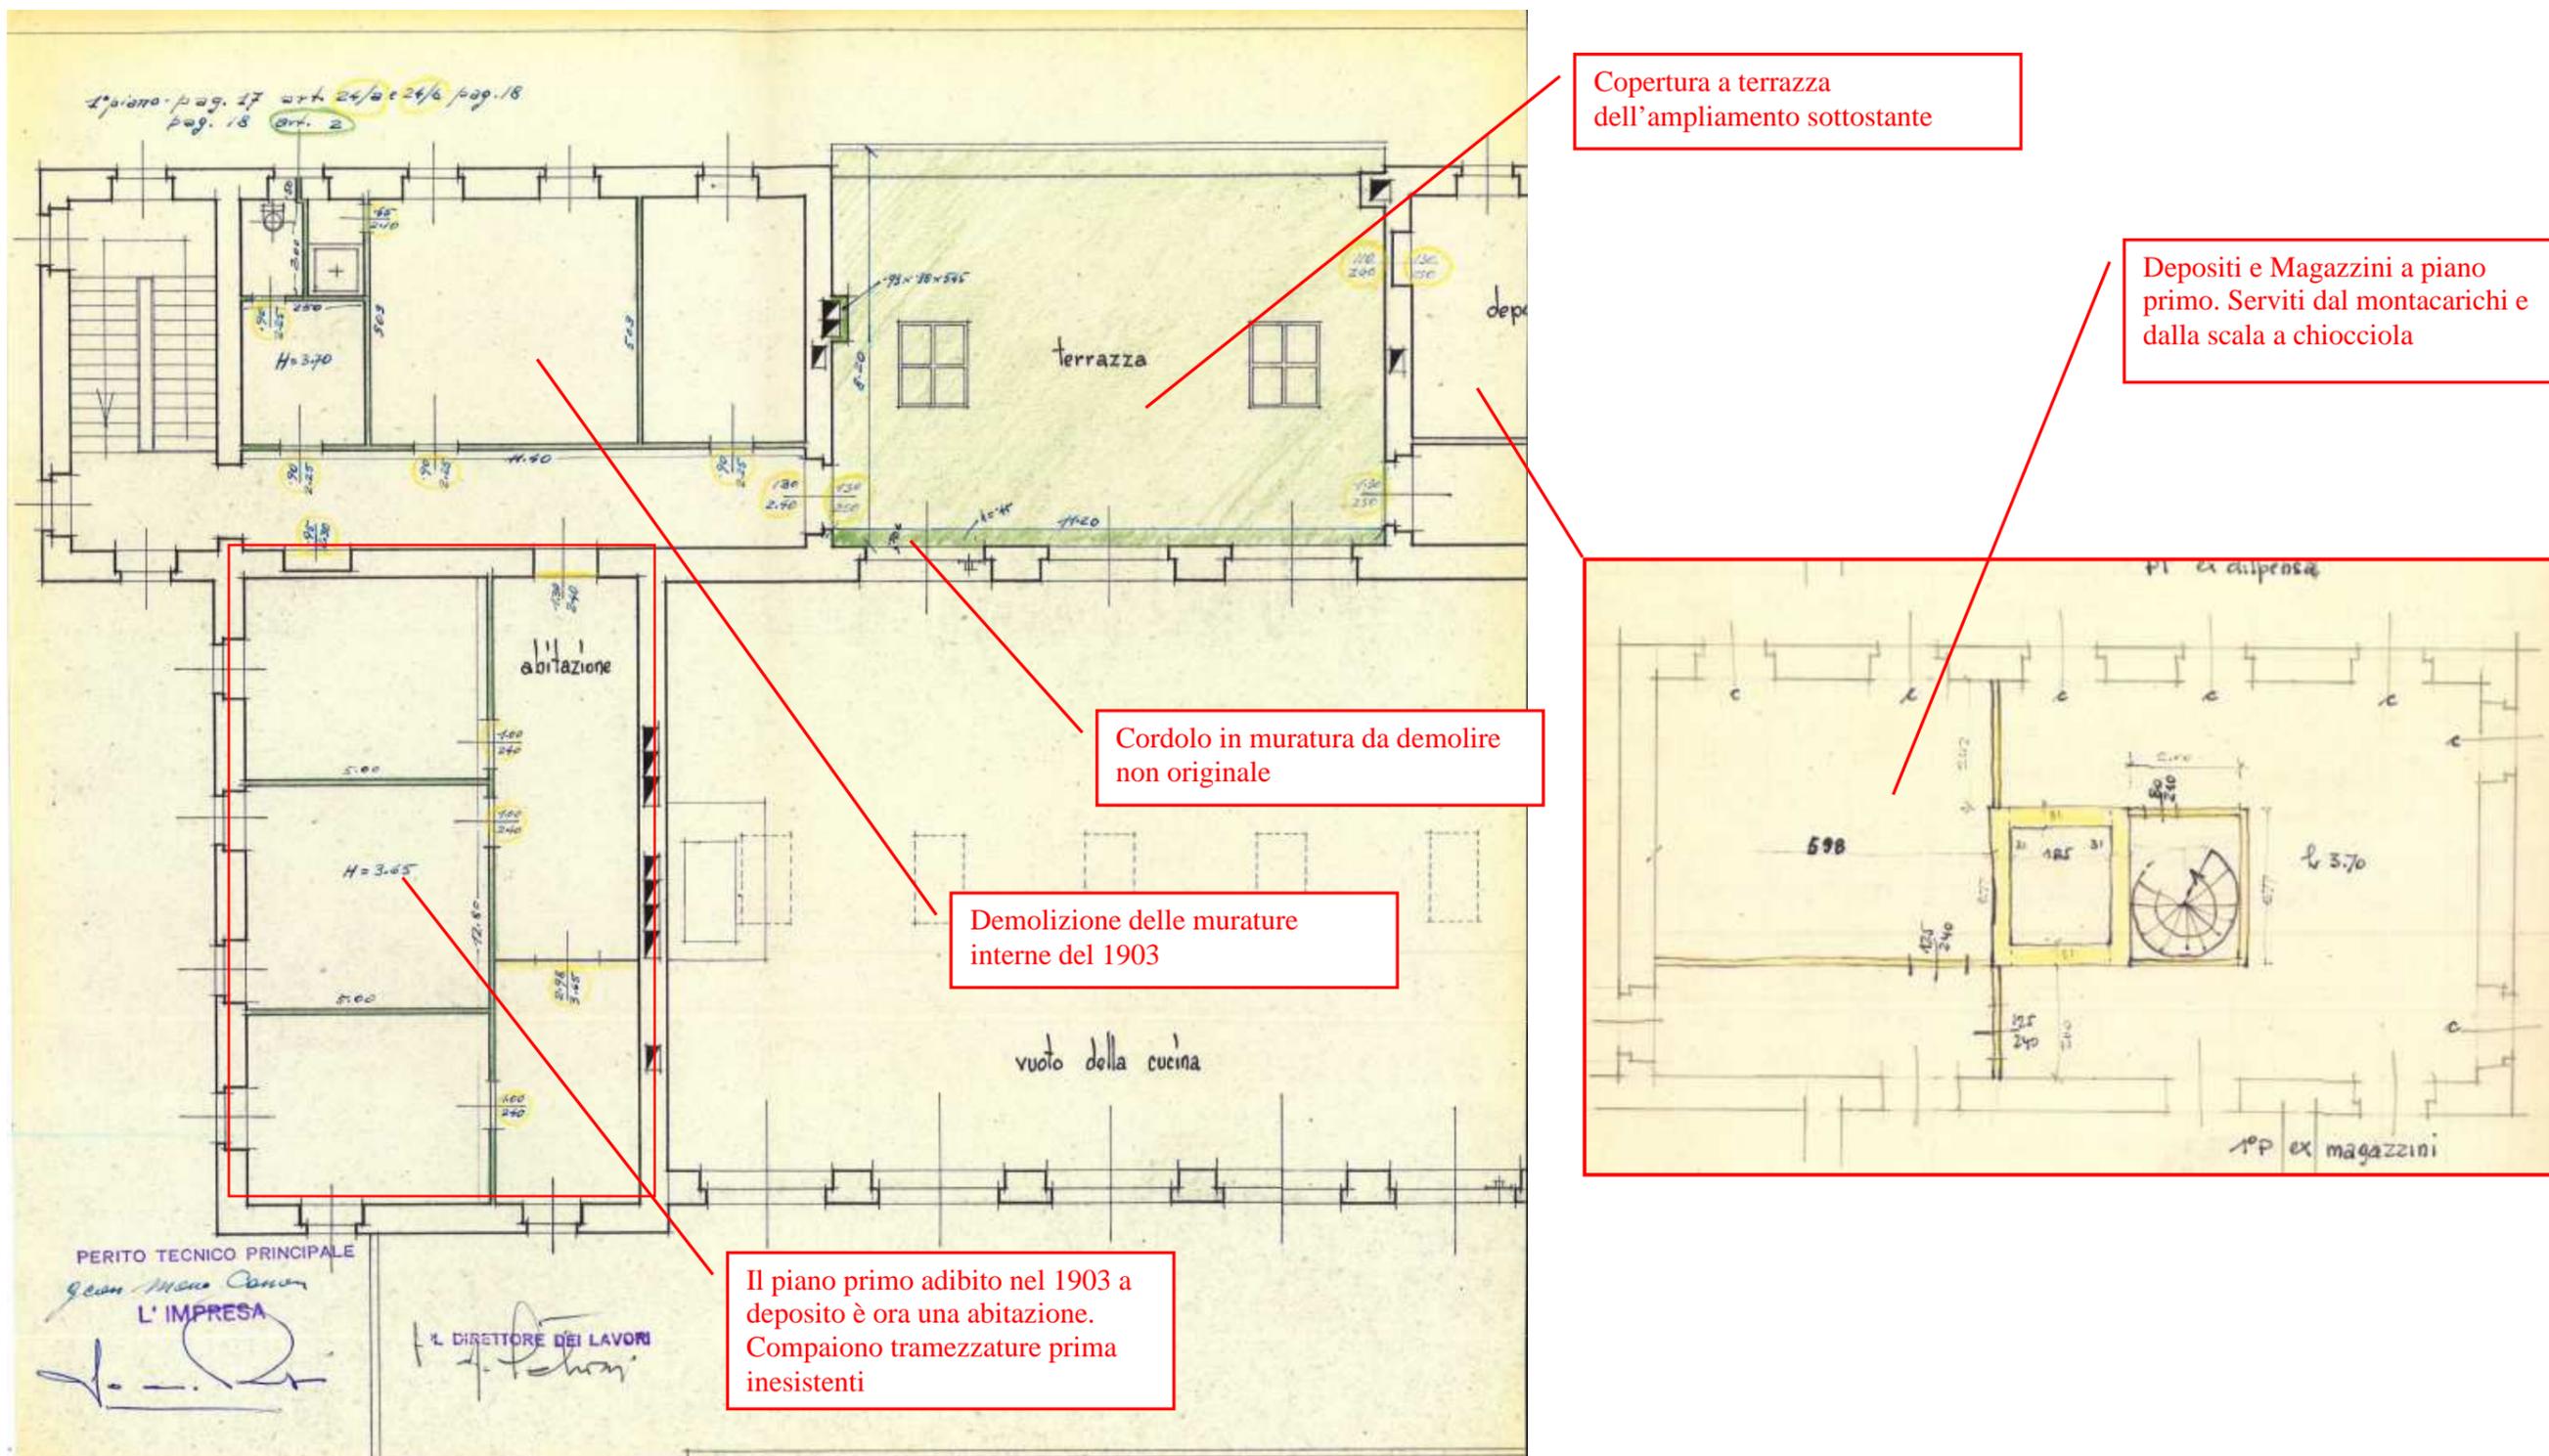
Pianta piano primo lato Ovest Murature demolite
